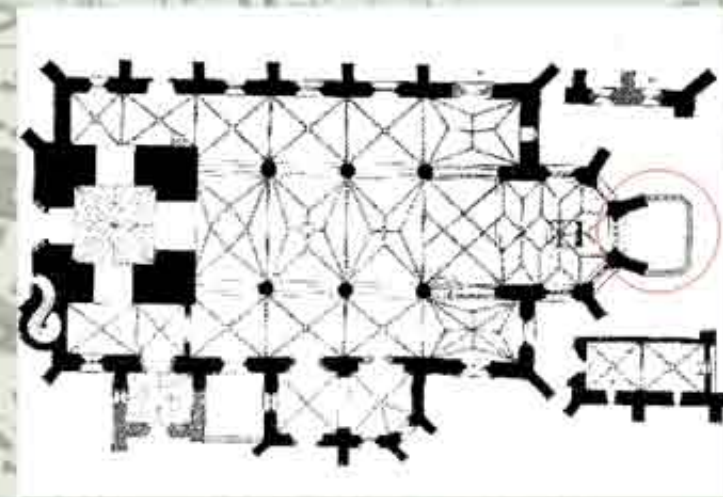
Der Grundriss der Nicolaikirche nach Gurlitt mit Eintragung des Sakristeianbaus
